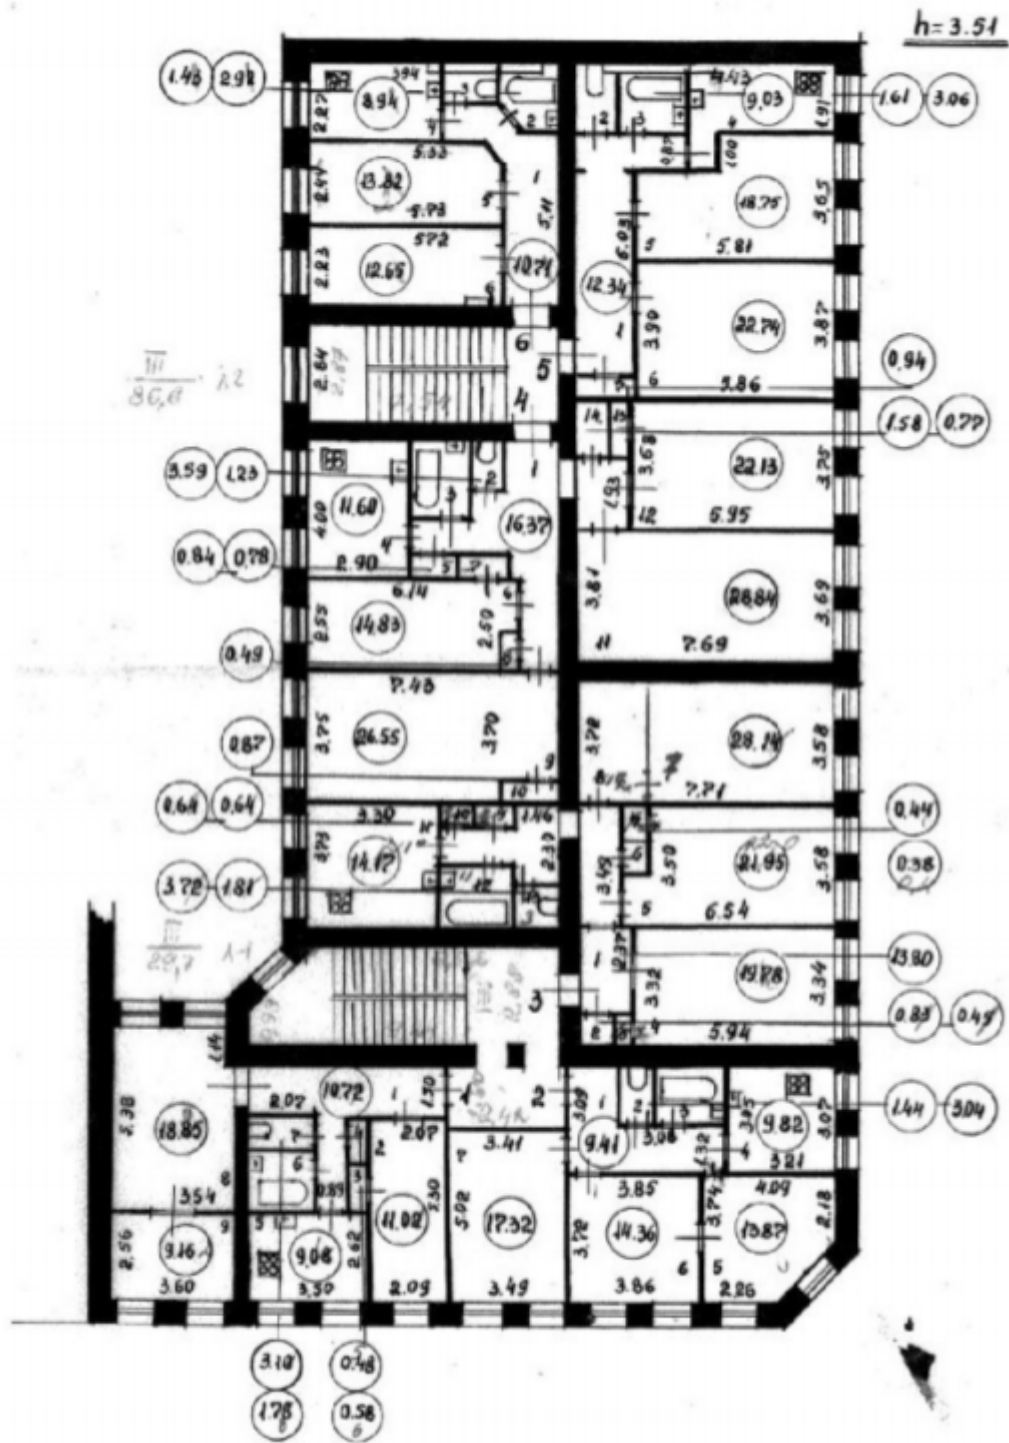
План 2-го этажа нежилого здания, входящего в состав Объекта оценки
